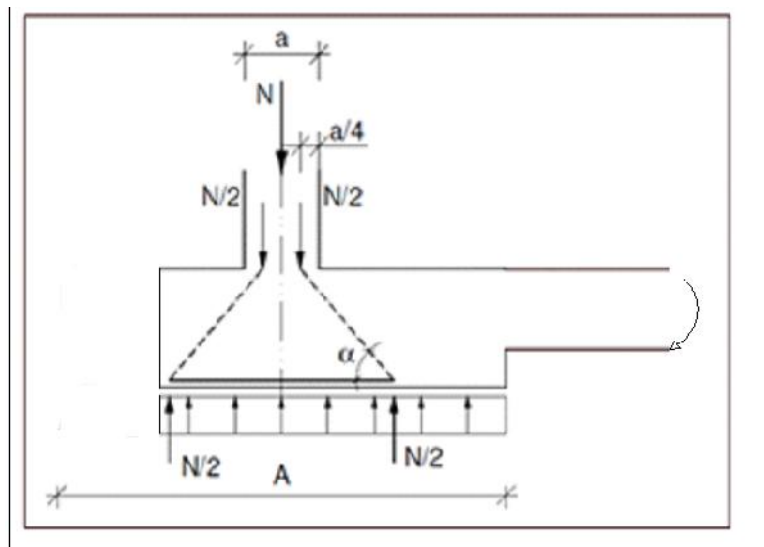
Esquema de uma sapata excêntrica com viga de fundação
